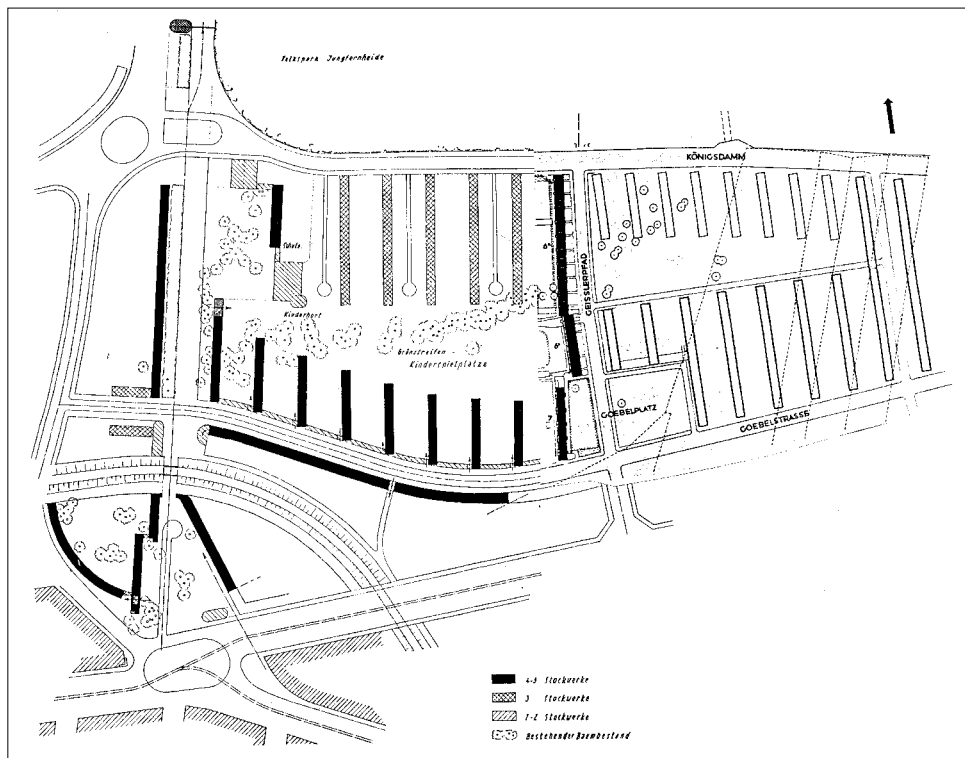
Bebauungsplanung Großsiedlung Siemensstadt. Planmontage aus: Entwurf für Baueingabe 1929 (links) [Rading,1929] und Entwurf 'Bauabschnitt III' 1931 [Forbat,1931]
